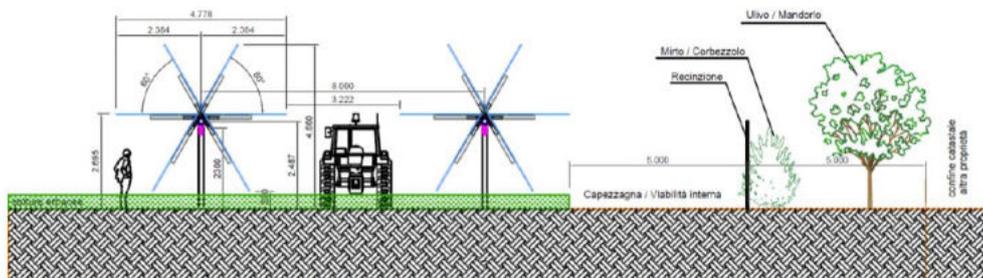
Fascia di mitigazione - schema in pianta del sesto di impianto
